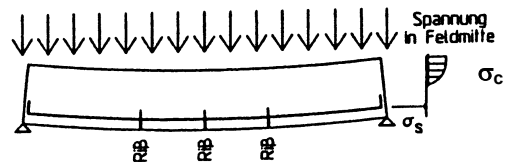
Unterschied im Spannungsverhalten Stahl/Holz zu Stahlbeton
